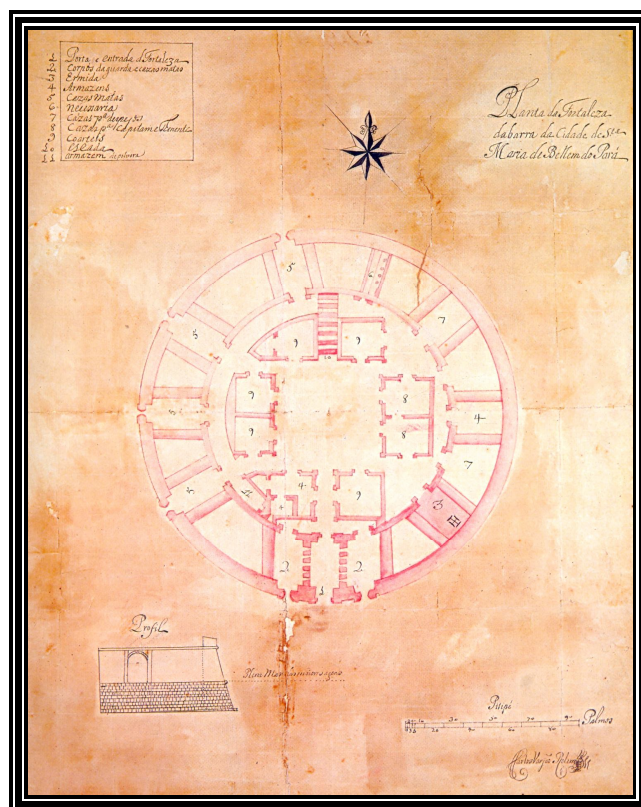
“Planta da Fortaleza da Barra”¹¹⁴
